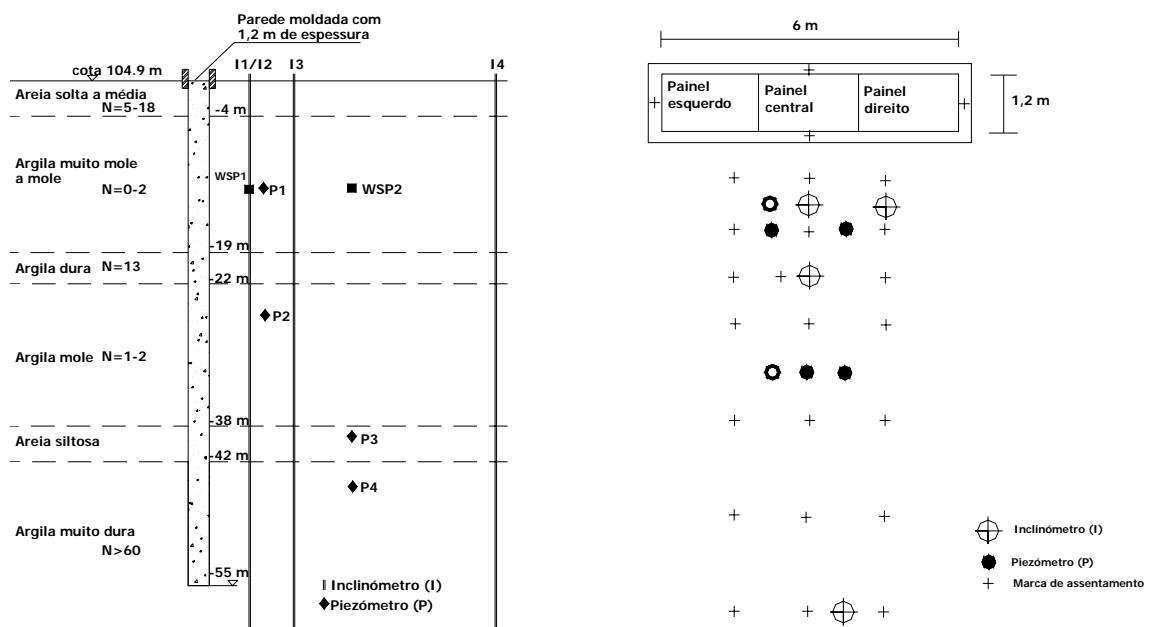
Perfil geotécnico e plano de instrumentação. (Poh e Wong, 1998)
